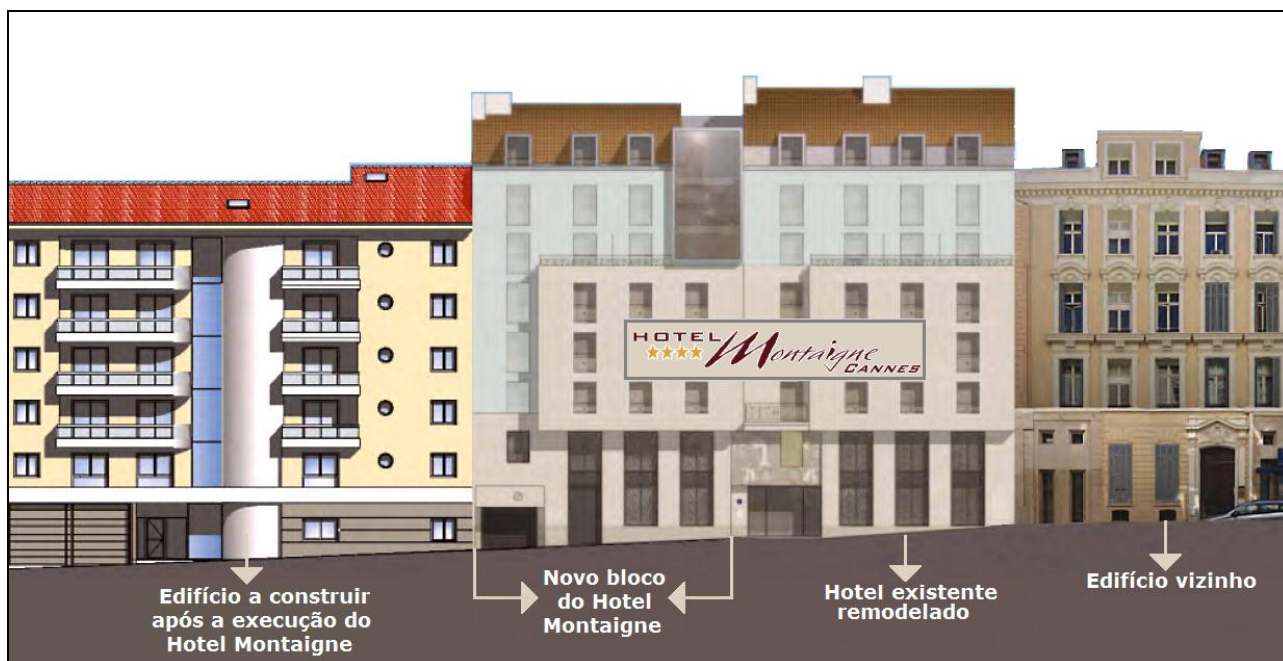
Enquadramento da Obra (vista da Rua Montaigne)
